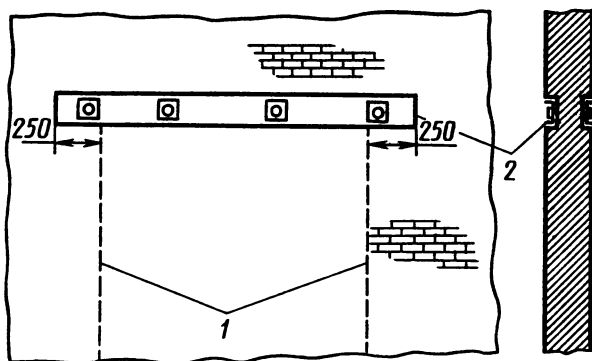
Схема закладки стальных балок перемычки при пробивке проема в стене:
